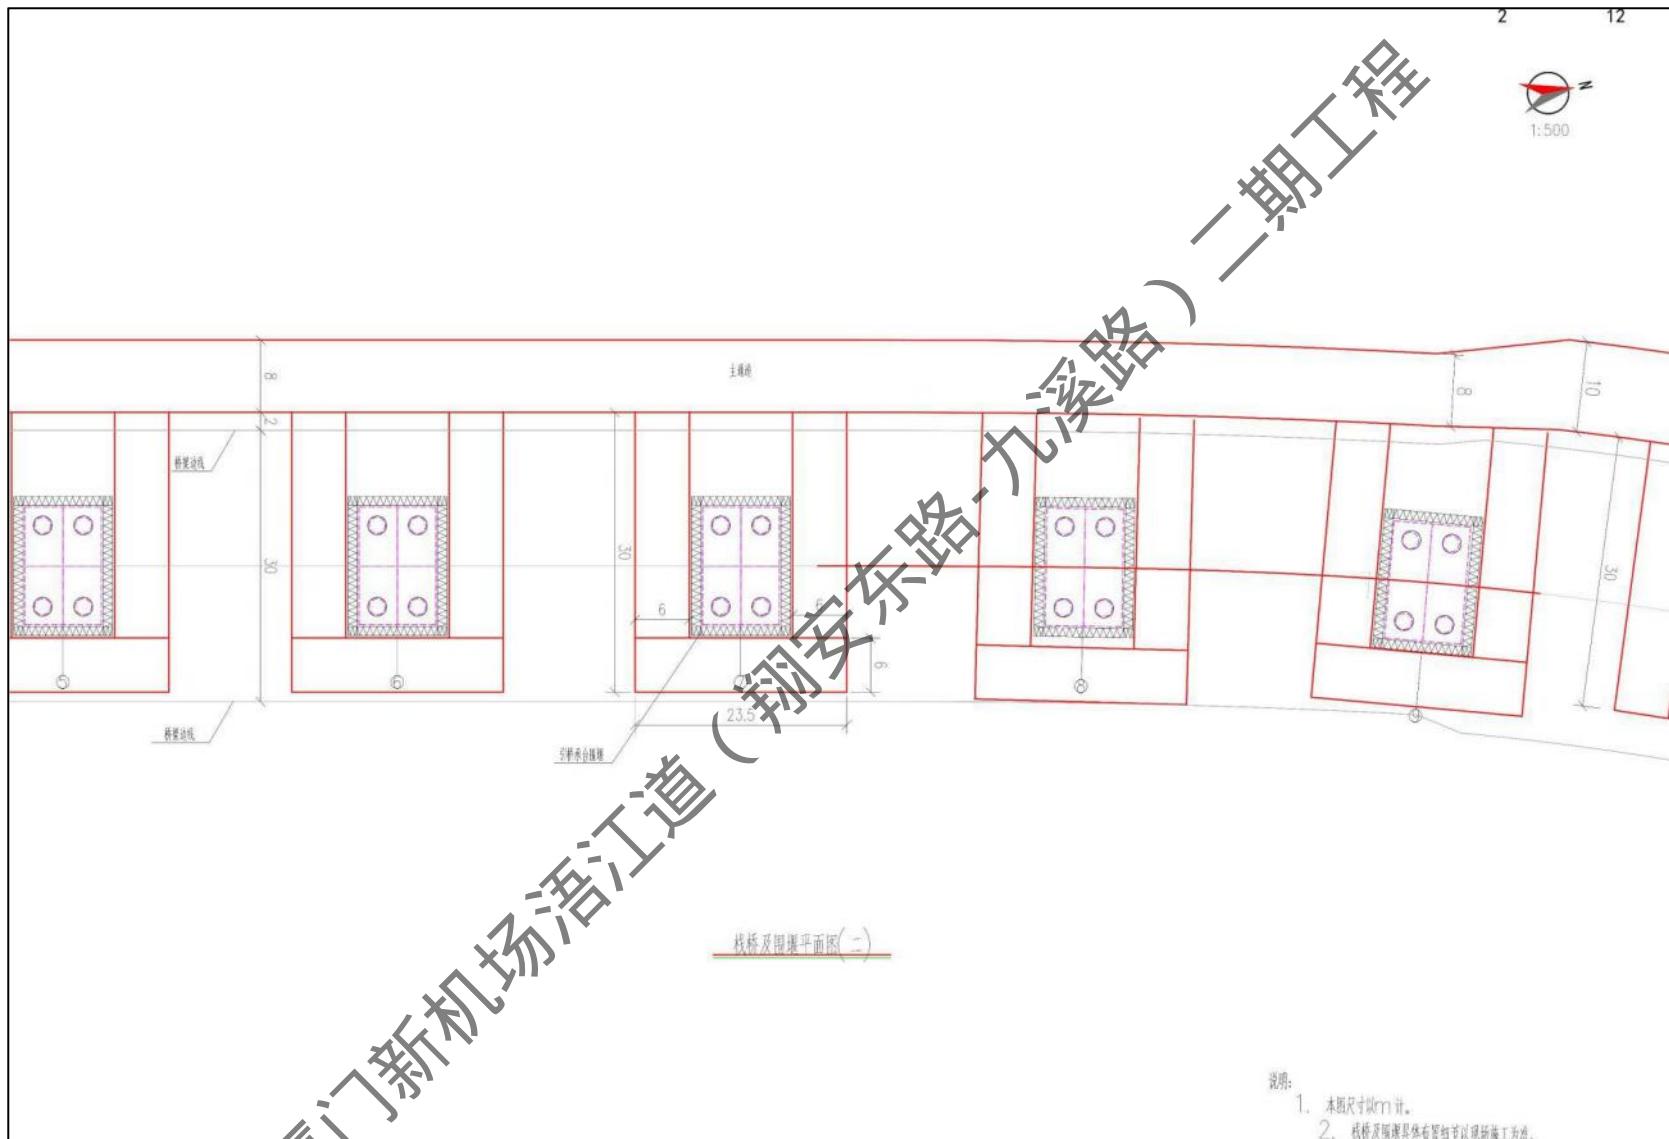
施工栈桥及围堰平面布置图（二）
